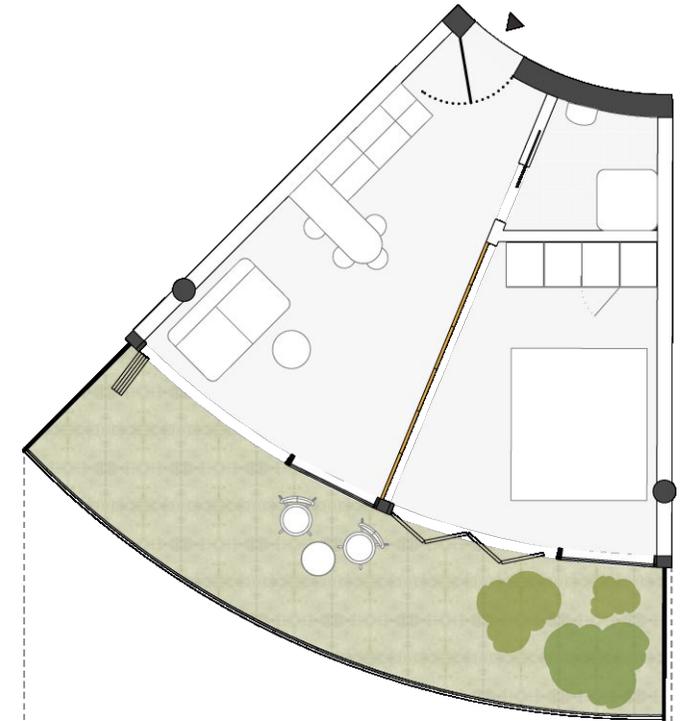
Grundriss Wohnung Typ A.a
